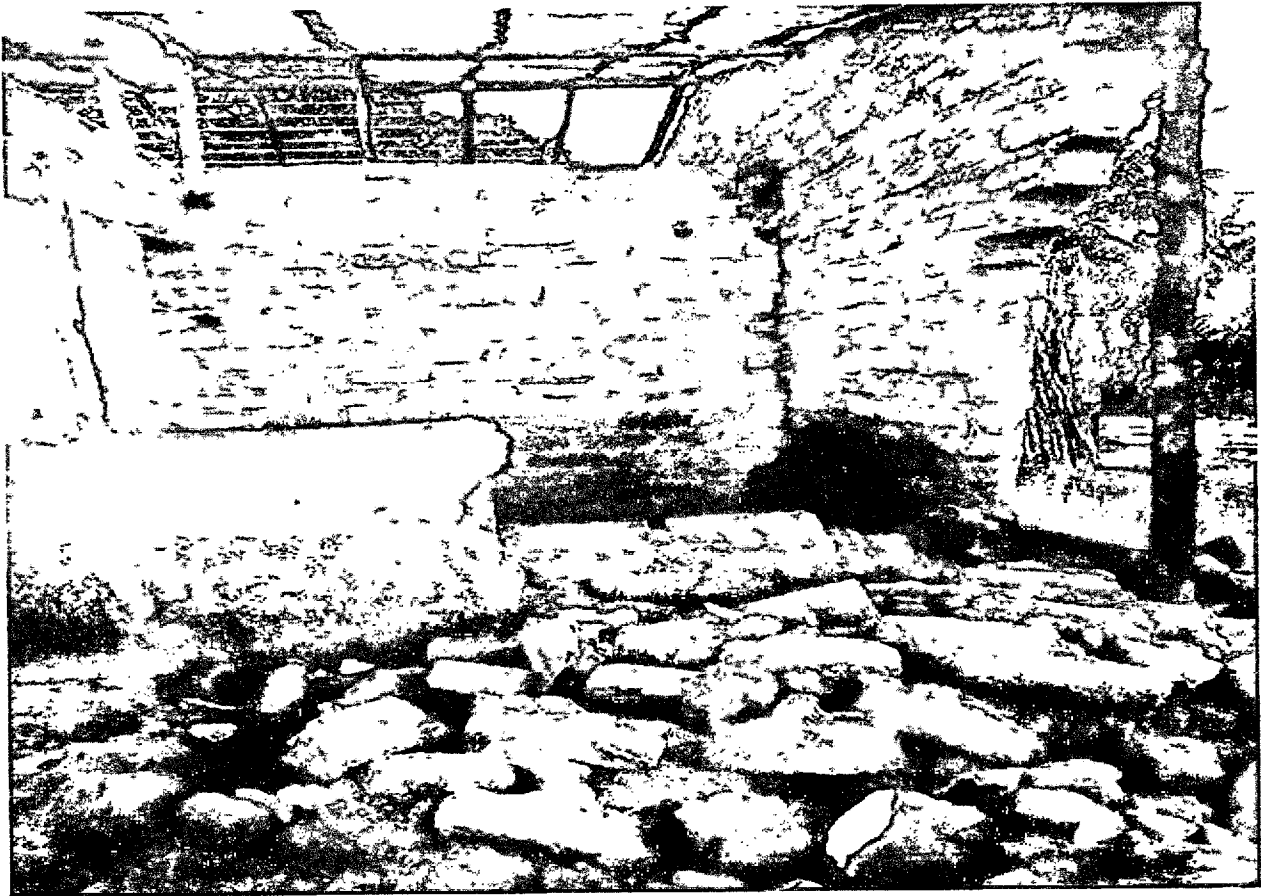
Casa destruída, Povoado Cruz, dia 20/03/2020
